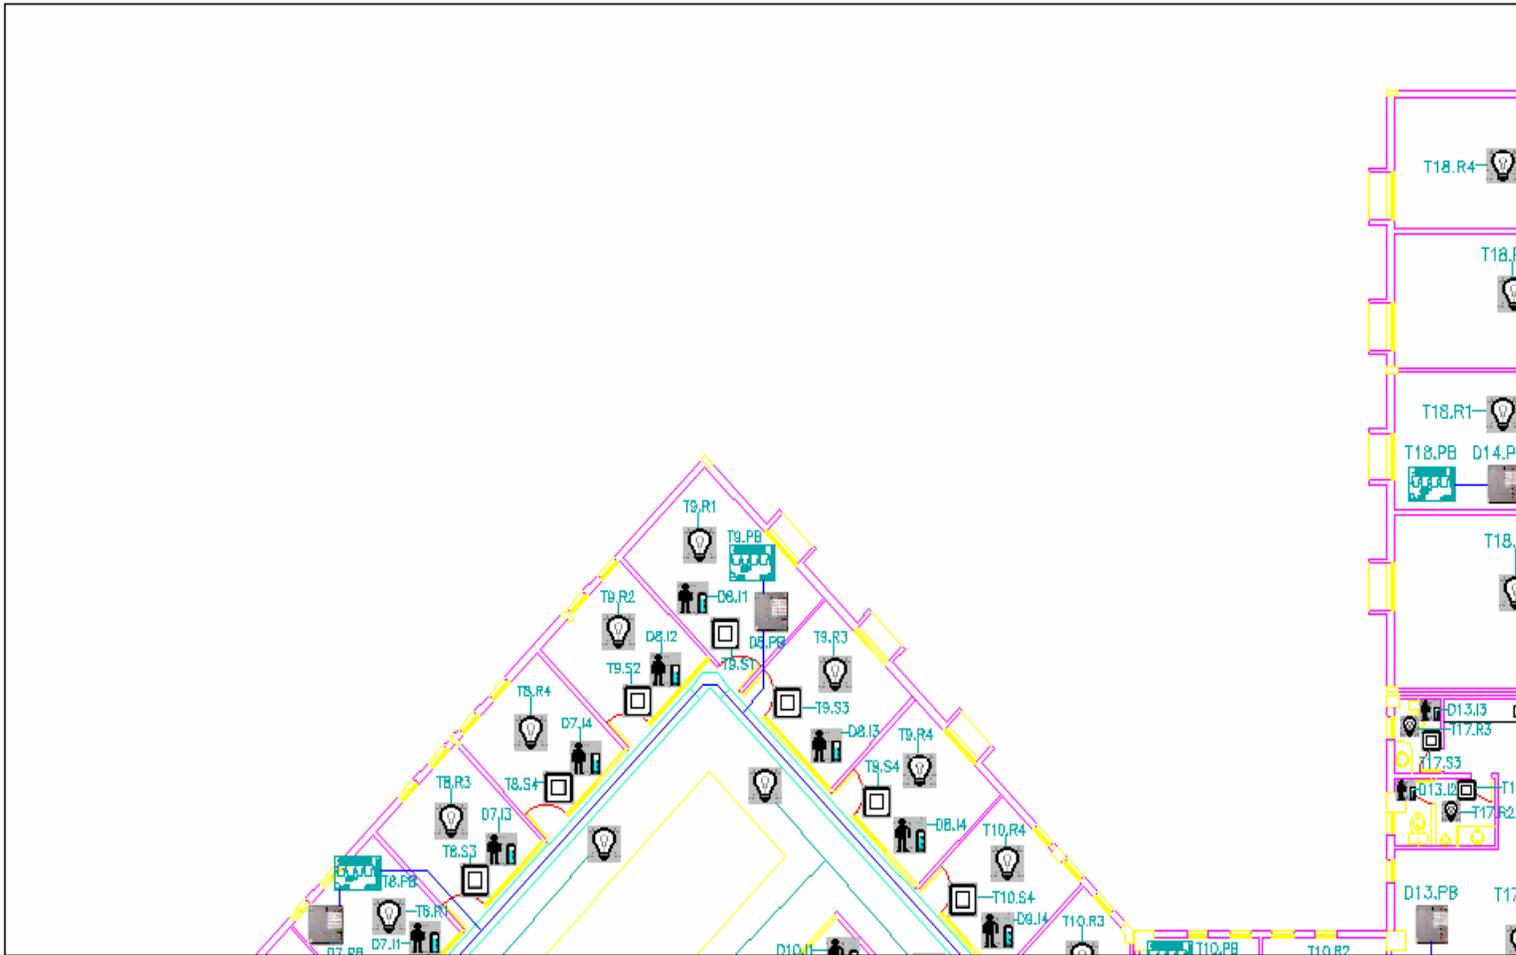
PLANO ILUMINACION PLANTA BAJA SECCION 7
